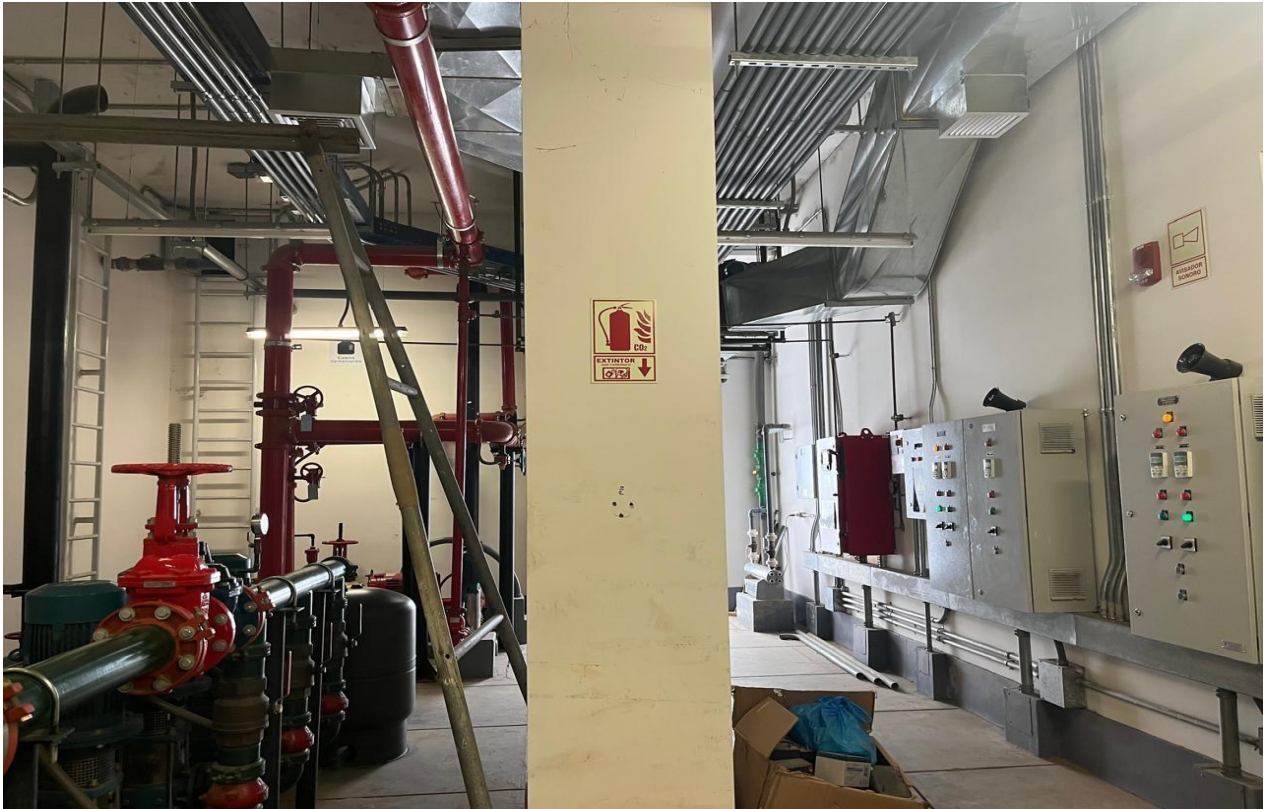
Asimismo se presenta fisuras con agrietamiento en lo que es el revestimiento de muros y columnas en el sótano.
